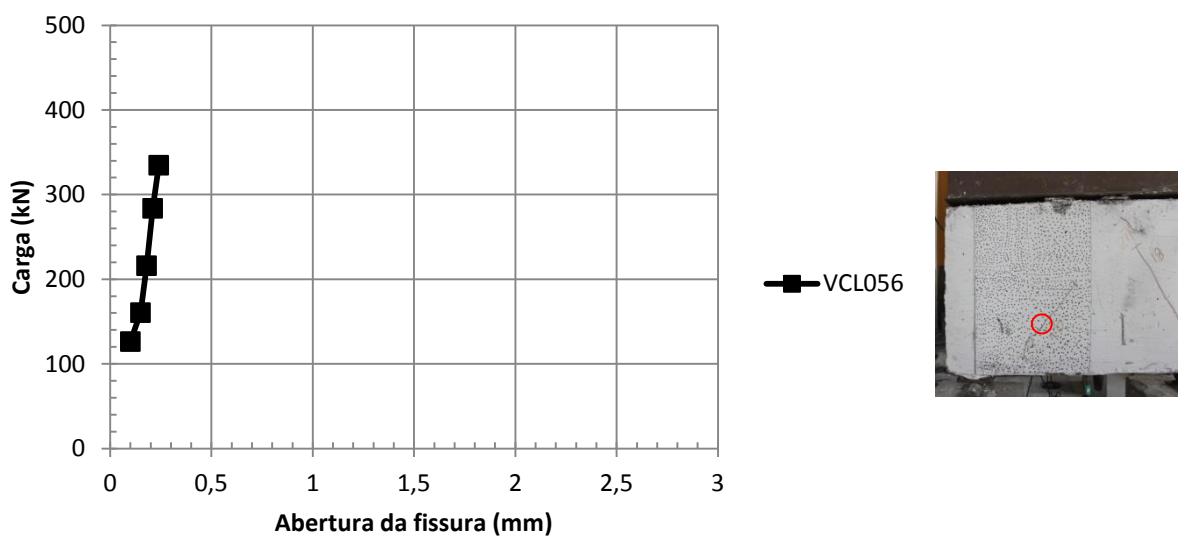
Evolução da abertura de fissuras na viga-parede VCL056.
